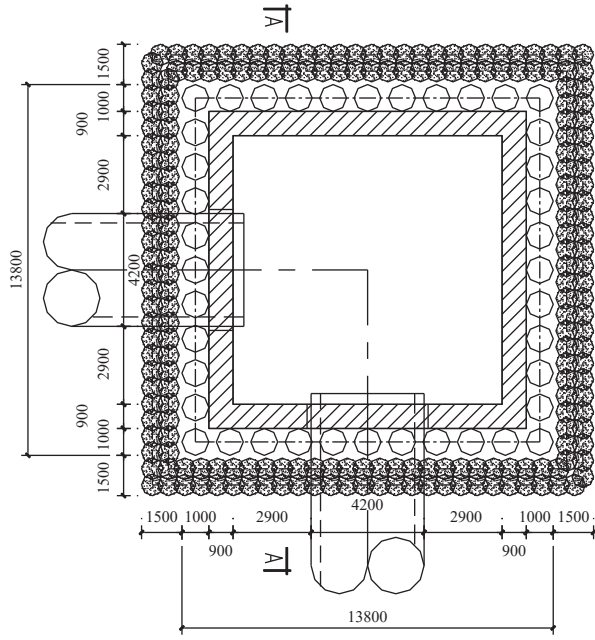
排桩围护明挖顺作井及其支护平面图(单位:mm)
